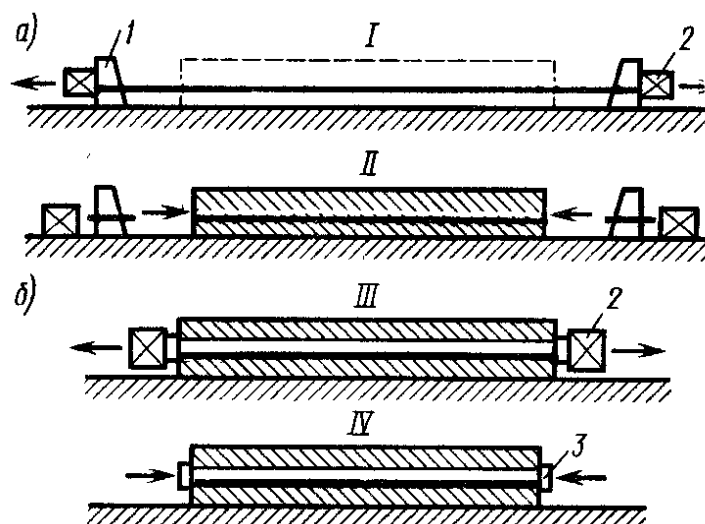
Создание предварительного напряжения: а – натяжение арматуры на упоры; б – натяжение арматуры на бетон; I – натяжение арматуры и бетонирование элемента; II, IV – готовый элемент; III – элемент во время натяжения арматуры; 1 – упор; 2 – домкрат; 3 – анкер
